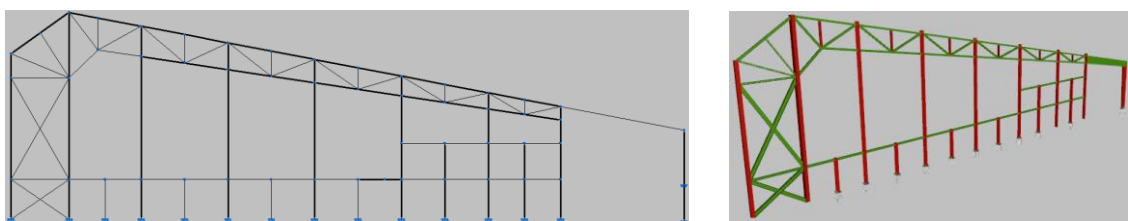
CYPE 3D – Pórtico interior oeste.
